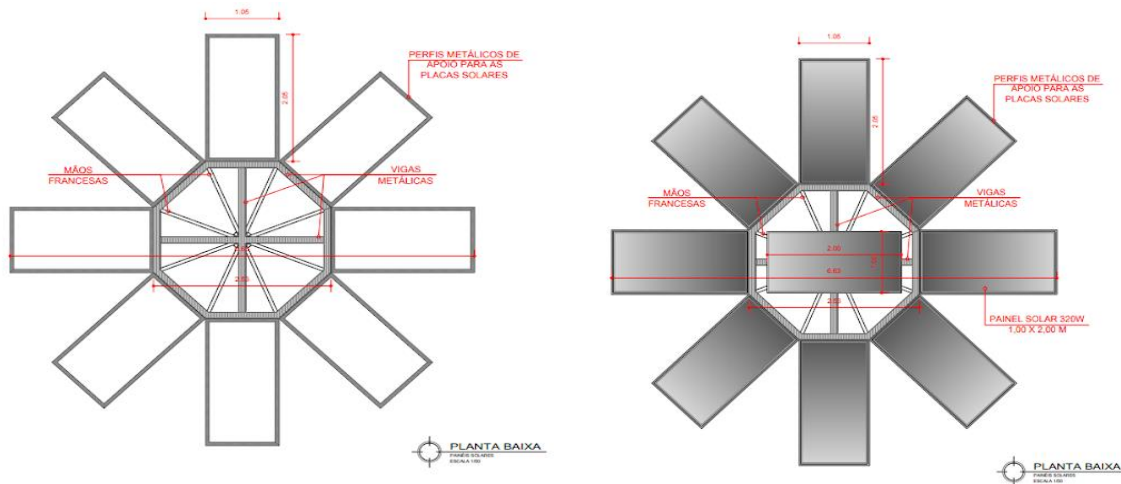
Planta baixa da estrutura dos painéis solares à esquerda e detalhamento da sua estrutura à direita do projeto executivo de captação de água subterrânea com sistema fotovoltaico. Fonte: Acervo CMA (2019).
